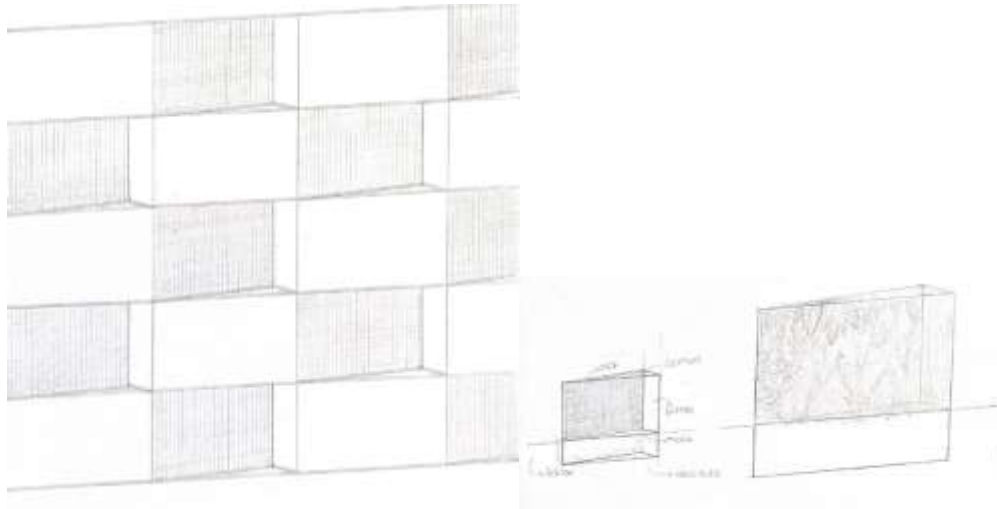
Boceto de fachada triangular con volumen. Fuente: Elaboración propia.
